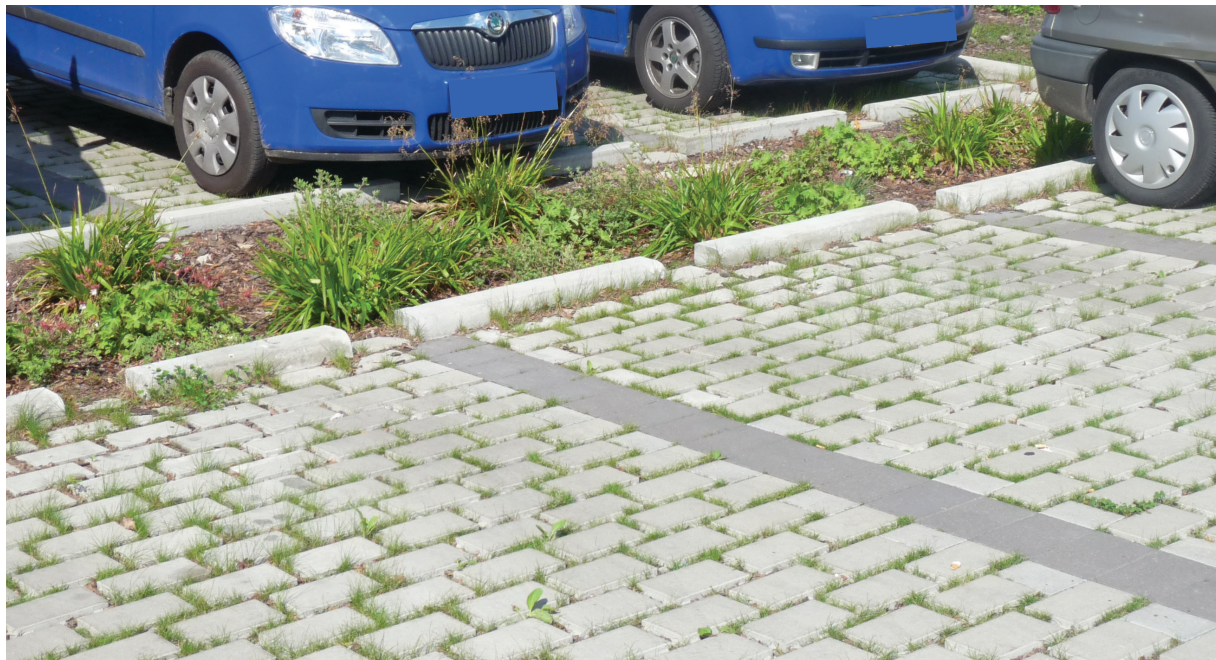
Wasserdurchlässiger Belag auf Parkplatz in Kombination mit Versickerungsbeeten [9]
